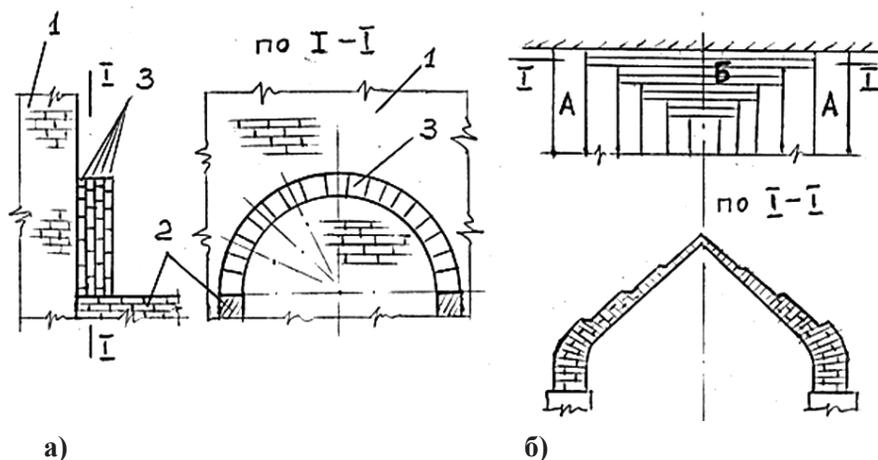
Возведение сводов: а) – кладка сводов без установки кружал и опалубки на тез-ганч растворе: 1 – торцовая стена; 2 – основание свода; 3 – отрезки (арки) свода; б) – комбинированный метод кладки сводов А – зона нормальной (клинчатой) кладки; Б – кладка вертикальными отрезками.
